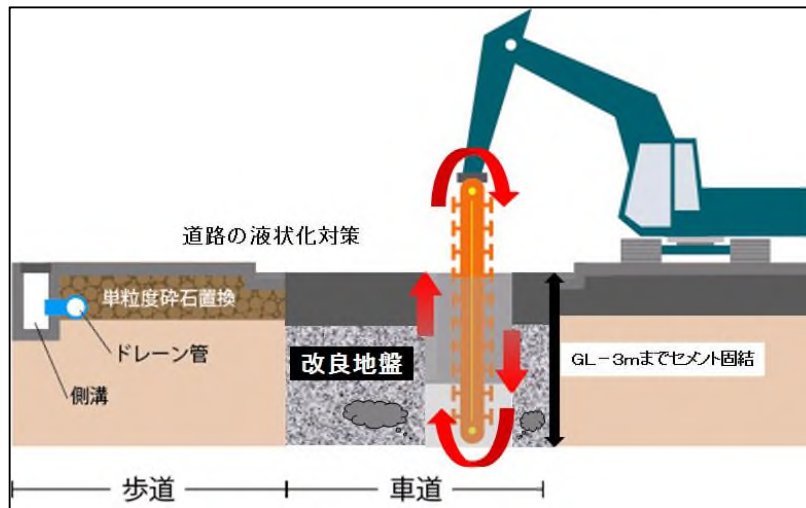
幹線道路（車道部、歩道部）の液状化対策工事の概要
